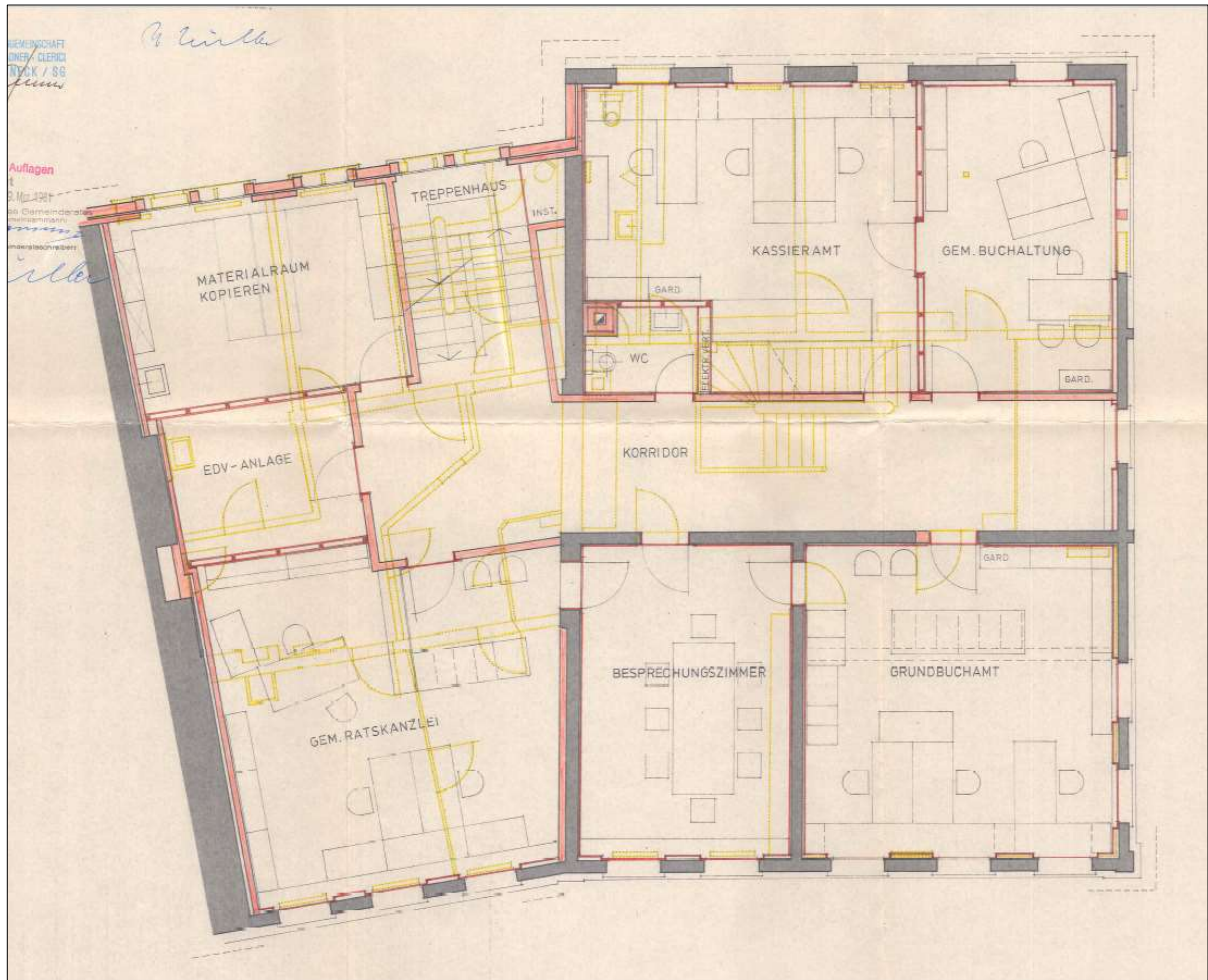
Grundriss 1. Obergeschoss. Projektplan von 1981.¹⁵ Diese Planung wurde mit kleinen Abweichungen umgesetzt.
